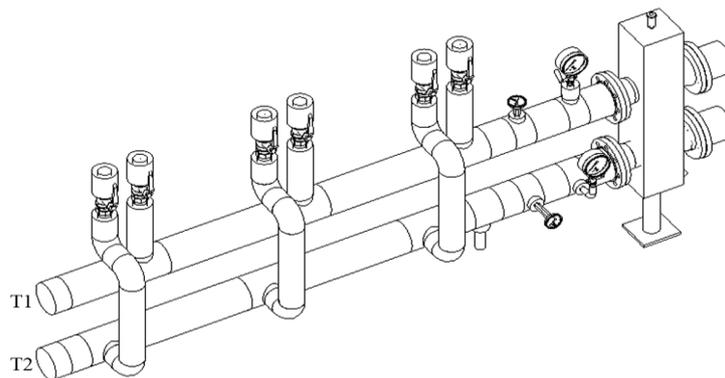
Модель блока соединительных трубопроводов: Т1 – подающий трубопровод тепловой сети; Т2 – обратный трубопровод тепловой сети
